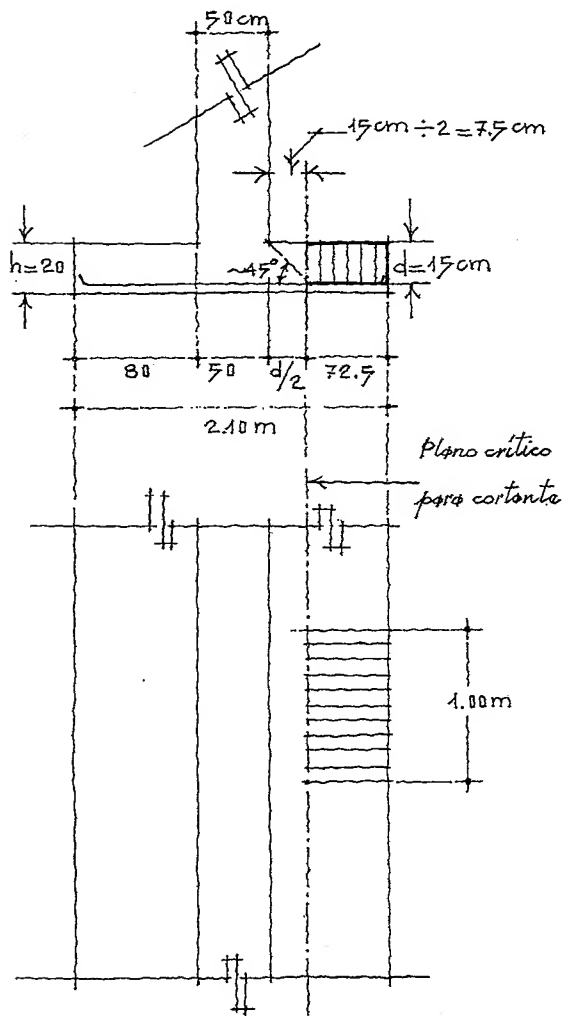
Planta de la zapata mostrando el plano crítico.
